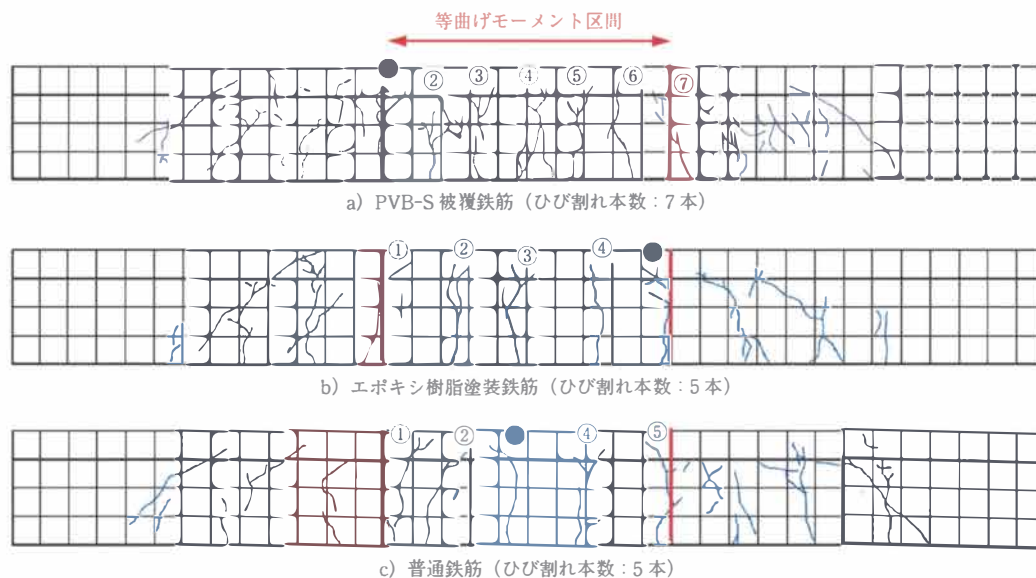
繰返し曲げ荷重試験後のひび割れ発生状況
